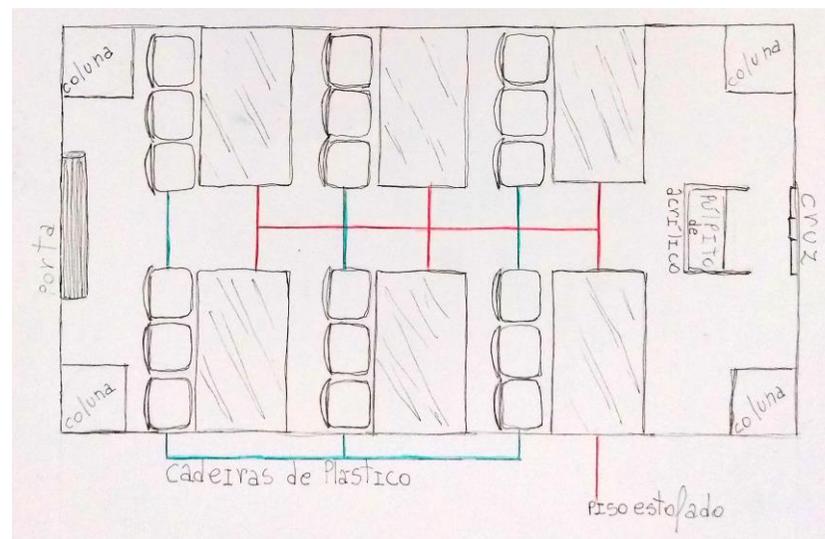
Capela (planta). Fonte: acervo pessoal.
